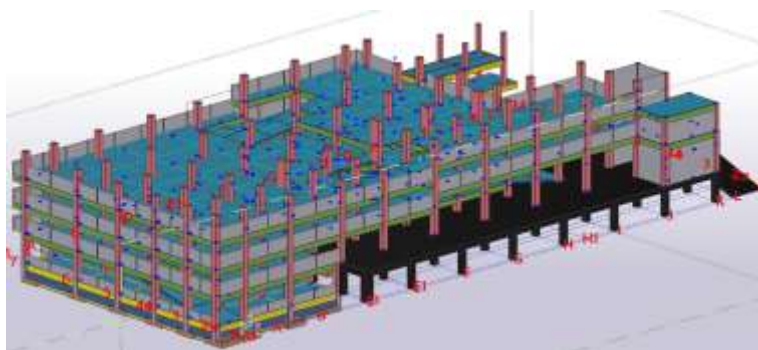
Penggambaran grid dan denah rencana pondasi dan pile cap
